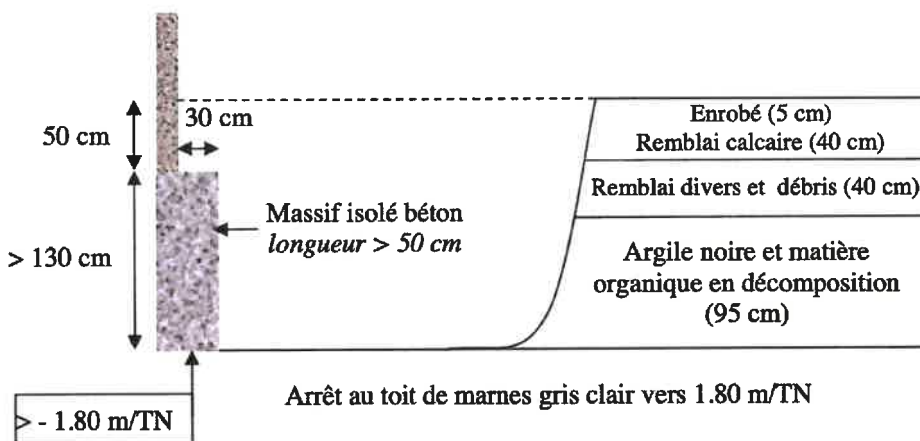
Coupe de synthèse de la fouille réalisée au droit de la fondation du pignon existant (RF1) - Extrait du rapport DIAG-SOL
